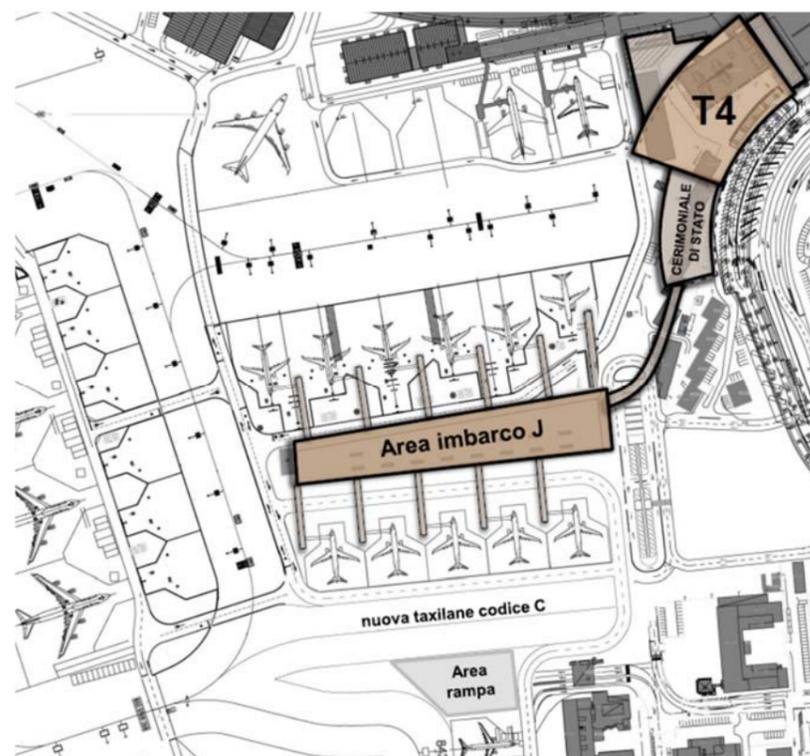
NUOVA AREA DI IMBARCO J AL COMPLETAMENTO DI PIANO
